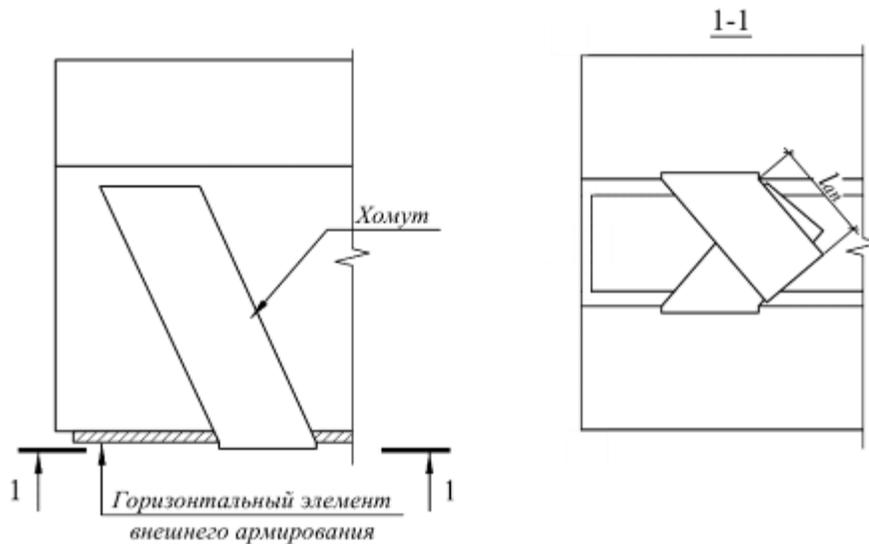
Схема установки наклонных хомутов в балочных конструкциях
